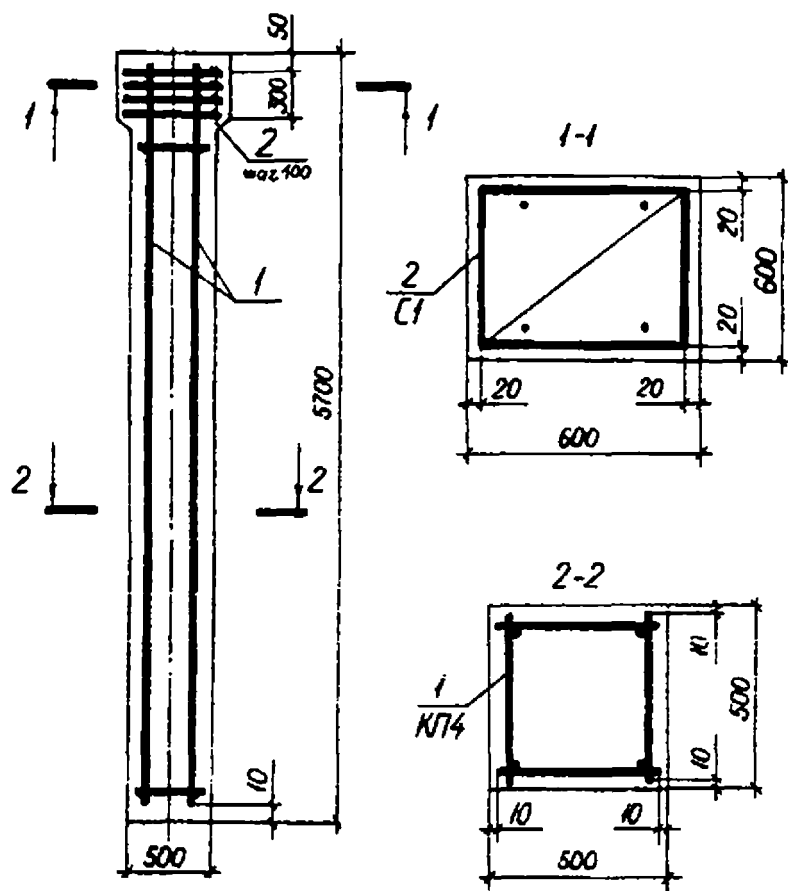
Схема армирования колонны К5 и разрезы к схеме армирования
